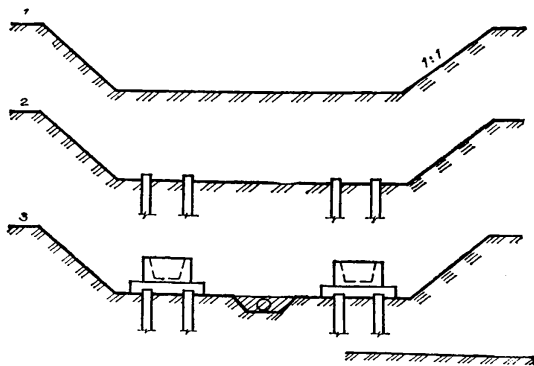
Очередность совмещенного выполнения работ (1 – 3) по устройству свайных фундаментов и трубопроводов
